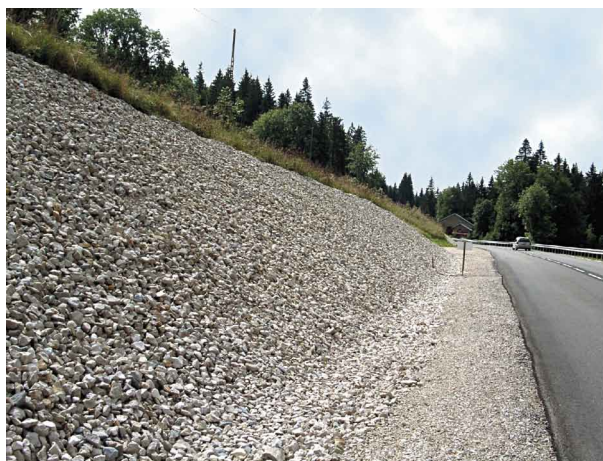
RD 991 (Ain) masque drainant avec butée et drain longitudinal de pied
